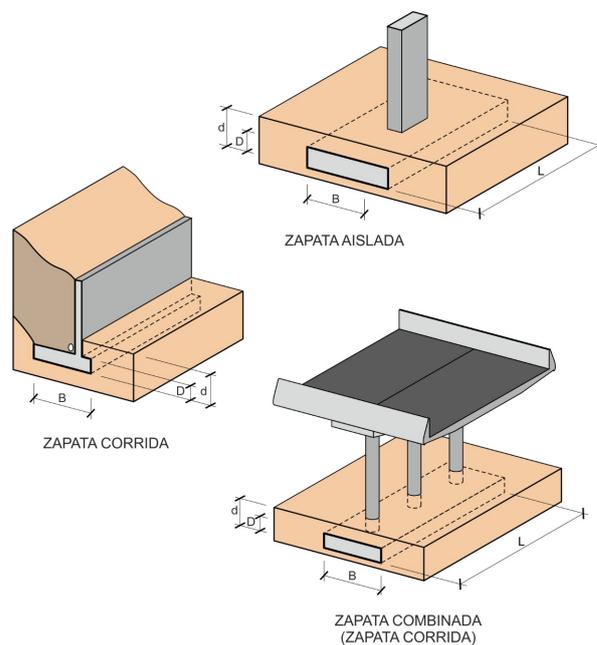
Tipos de cimentación superficial contemplados en la Guía
